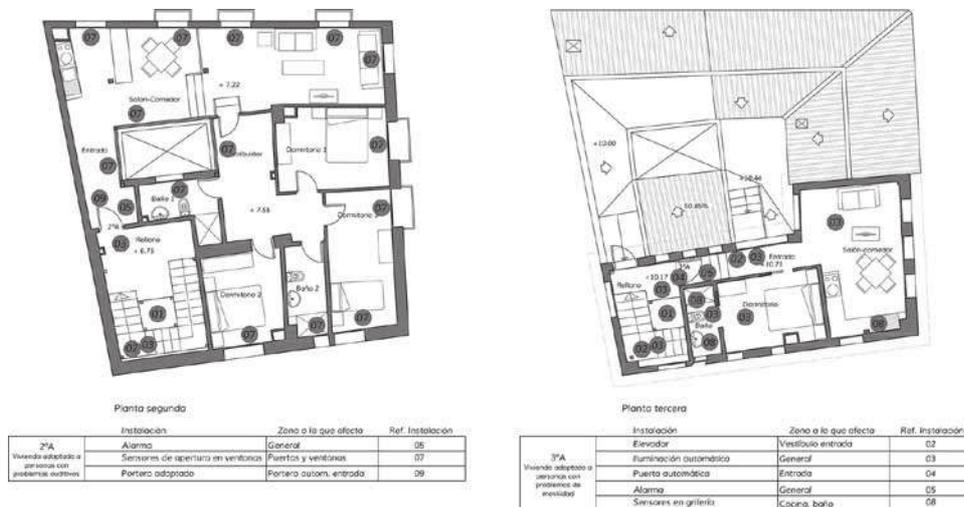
Plano con medidas domóticas a instalar y ubicación en restauración de edificio de viviendas plurifamiliares. Plantas segunda y tercera.
